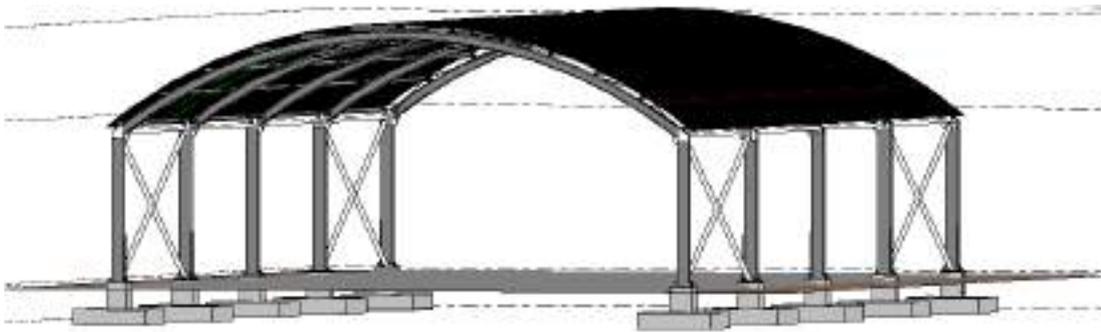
Vista en 3D de cobertura de estructura metálica.
